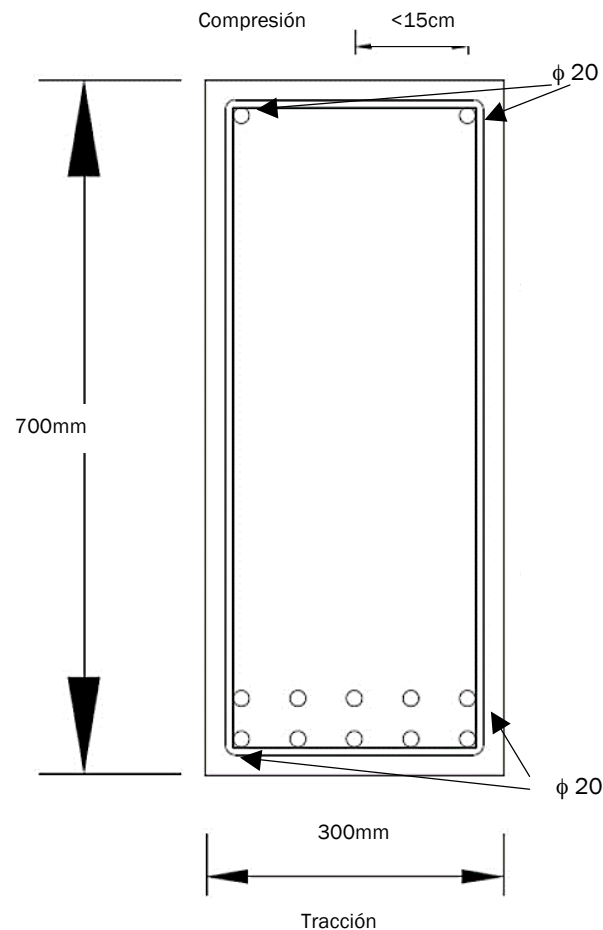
Disposición de la armadura en la viga 1. Fuentes: Elaboración propia.
